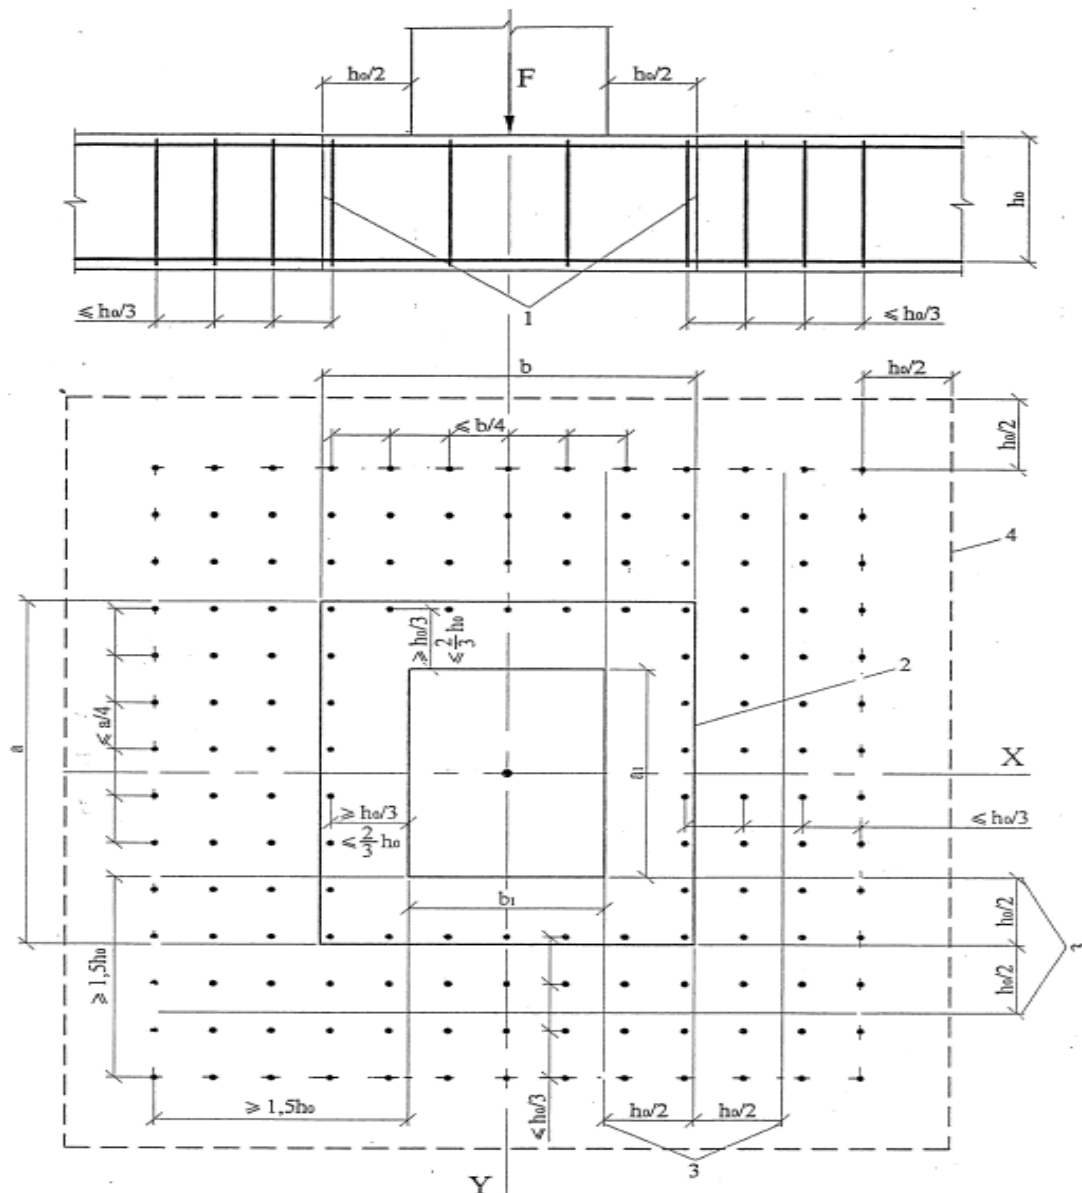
Схема для расчета железобетонных плит с вертикальной равномерной распределенной поперечной арматурой на продавливание.
